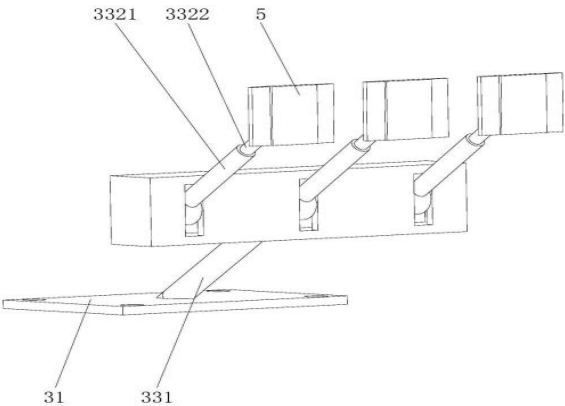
既有管线下方土方开挖施工方法的施工过程中即时支护装置隐藏了支护板后的结构示意图
